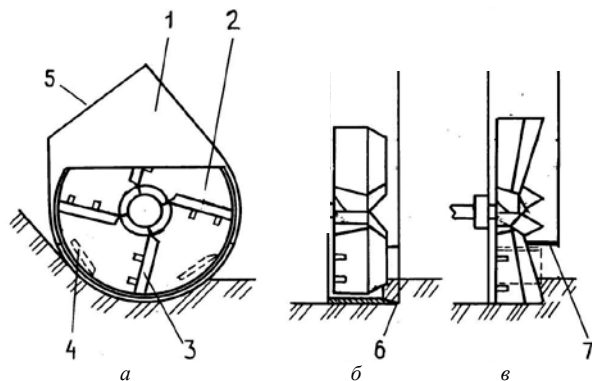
Схемы фрезерных рабочих органов с осью вращения, параллельной оси канала: *a* – вид спереди; *б* – вид сбоку фрезы с кожухом, опирающимся о дно; *в* – вид сбоку фрезы с кожухом, не опирающимся о дно; *1* – кожух; *2* – диск; *3* – ножи-лопатки; *4* – дополнительные ножи; *5* – выбросное окно; *б* – режущая кромка; *7* – противорежущая кромка
